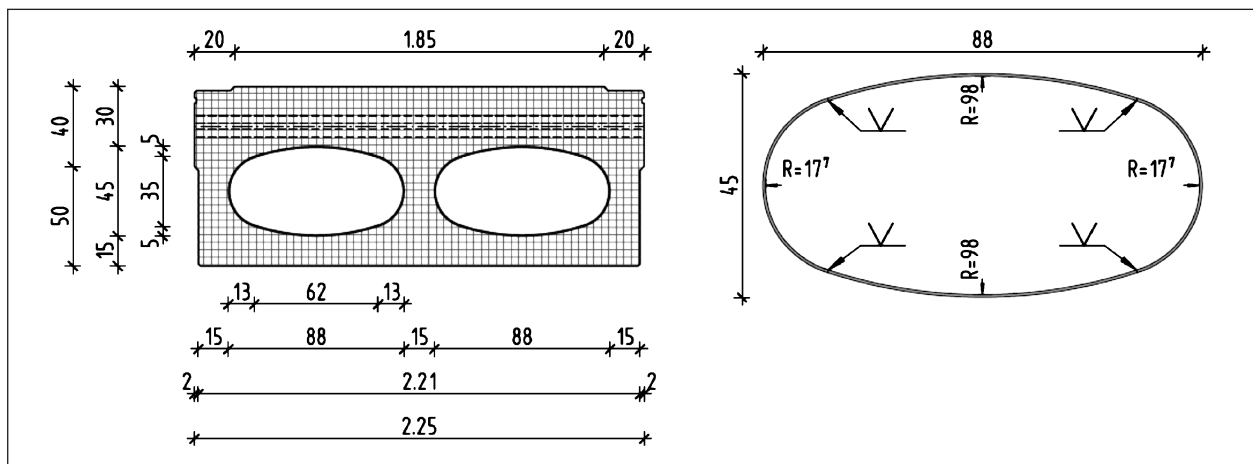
Details Variante 1 – Stahlquerschnitt Fertigteil mit Hohlkörpern
